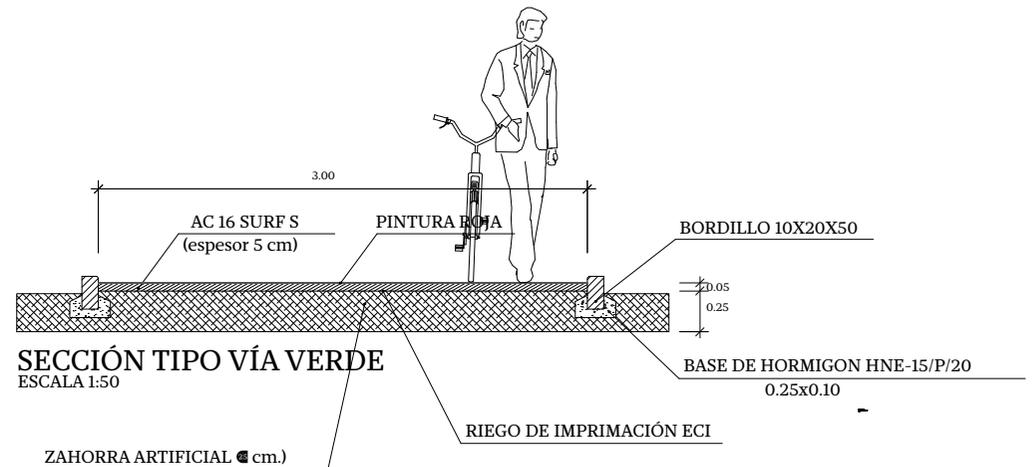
Sección tipo para la construcción de las Vías Verdes. Elaboración propia.
